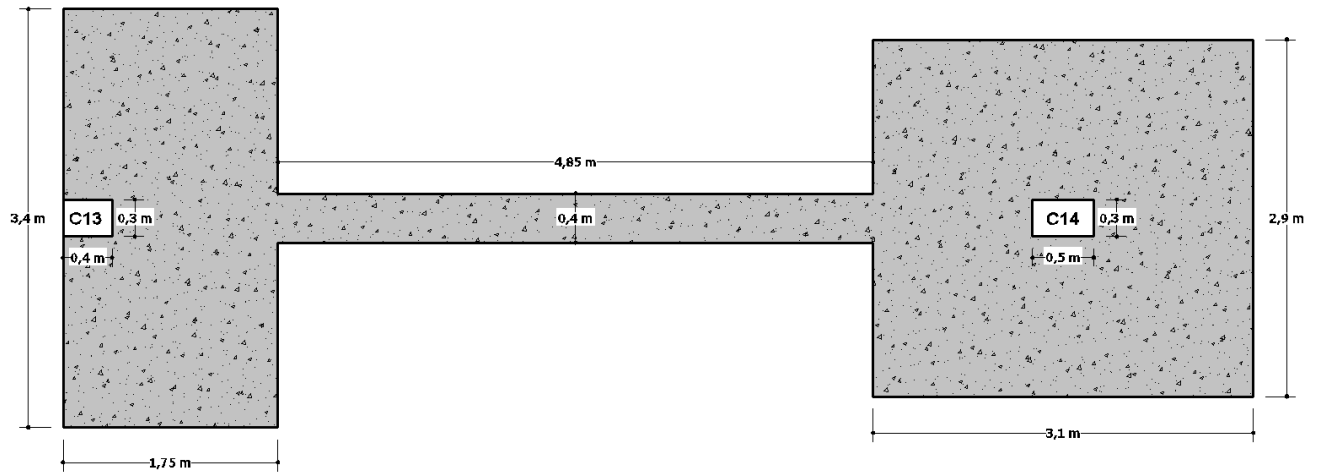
Despiece de Zapata Centrada; Elaboración Propia
